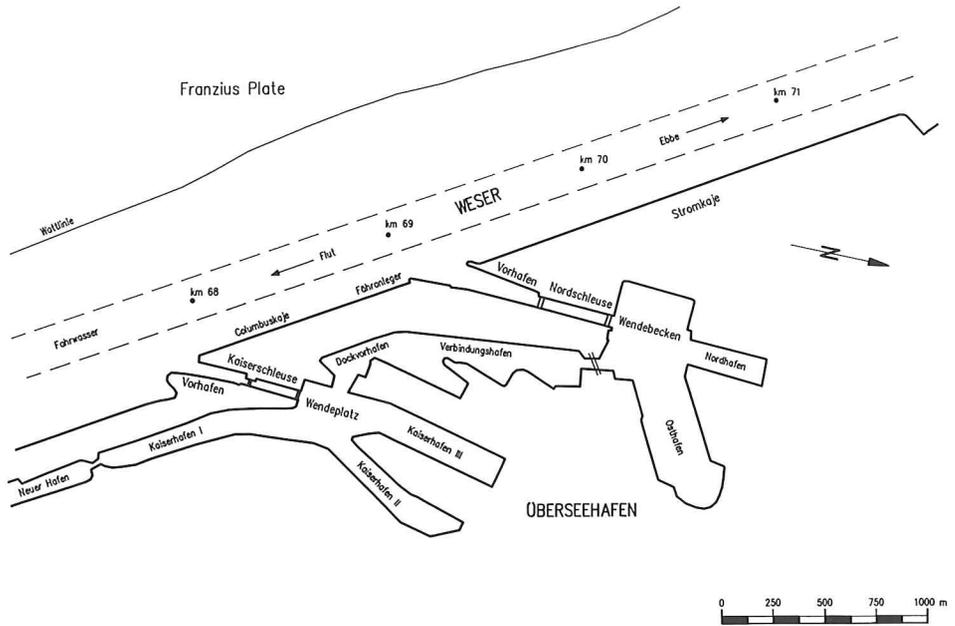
Hafenanlagen in Bremerhaven, Lageplan
